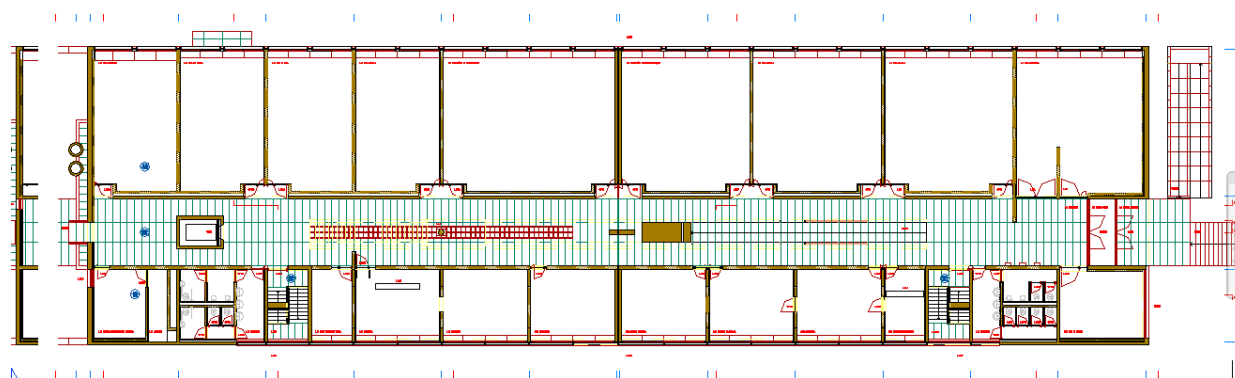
Vista da planta do Piso 1 do *Edifício X* (*AutoCAD*).
